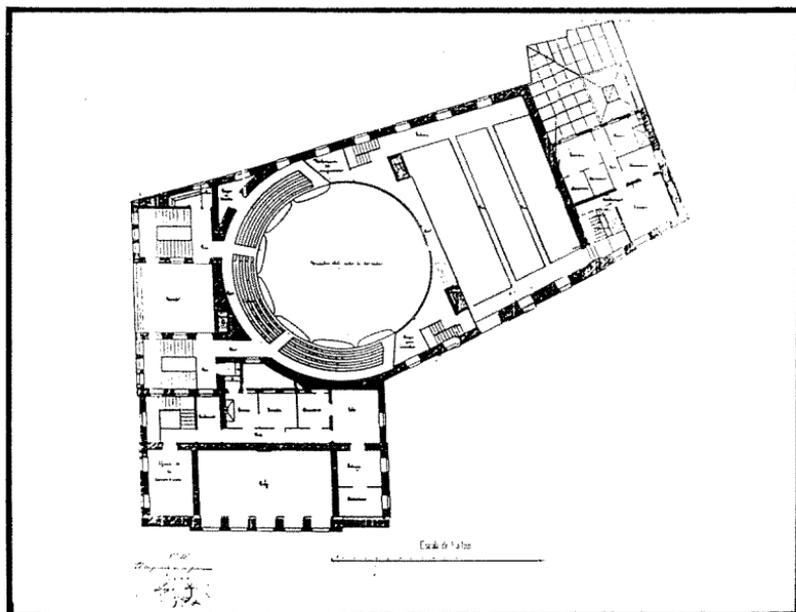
Proyecto de Amador de los Ríos. Planta tercera, 1870. (A.M.T.).
